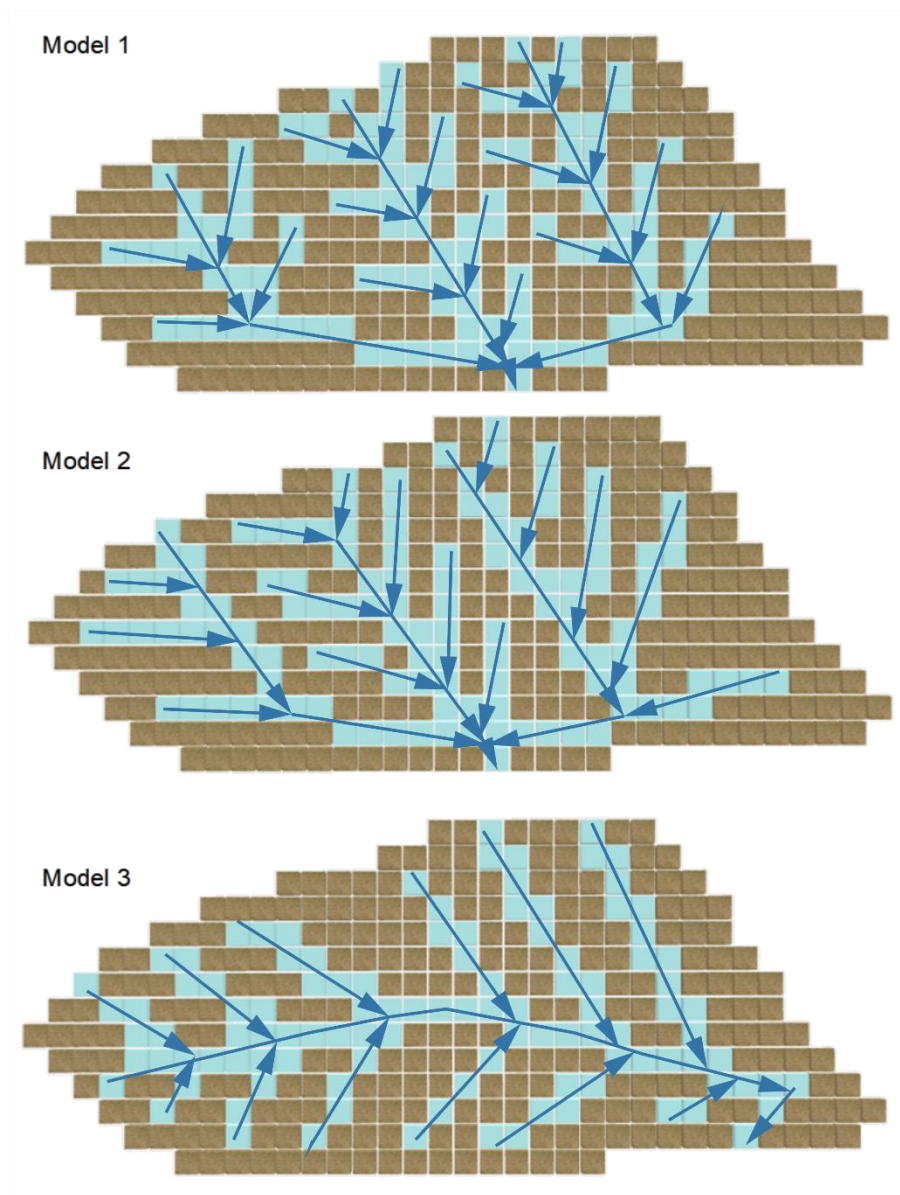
Variações dos desenhos do sistema de drenagem (sem escala): 1) planta com arranjo ramificado a; 2) planta com arranjo ramificado b e 3) planta com arranjo espinha de peixe.
